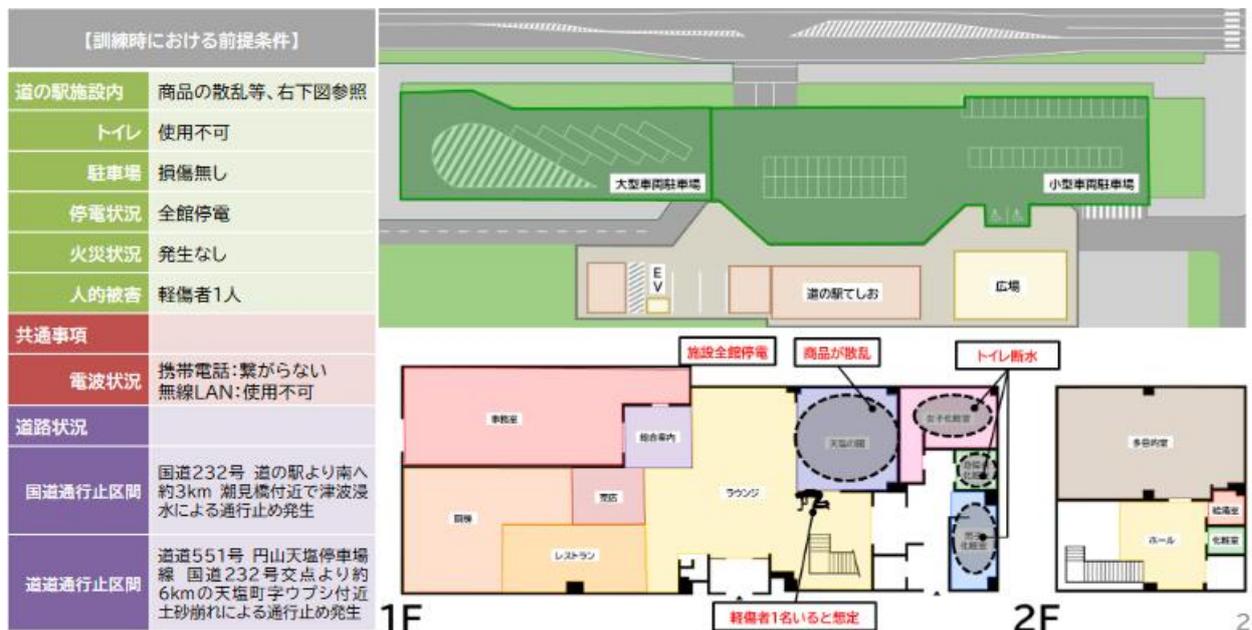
防災訓練時の被災状況(前提条件)及び道の駅「てしお」の平面図
